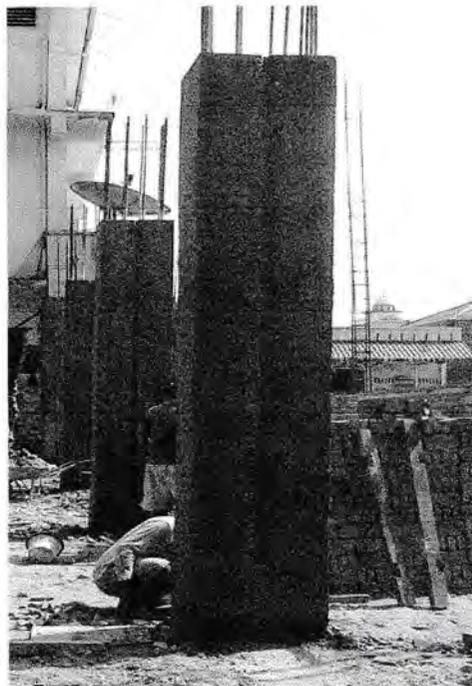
Pemasangan Bekisting Kolom Gedung
